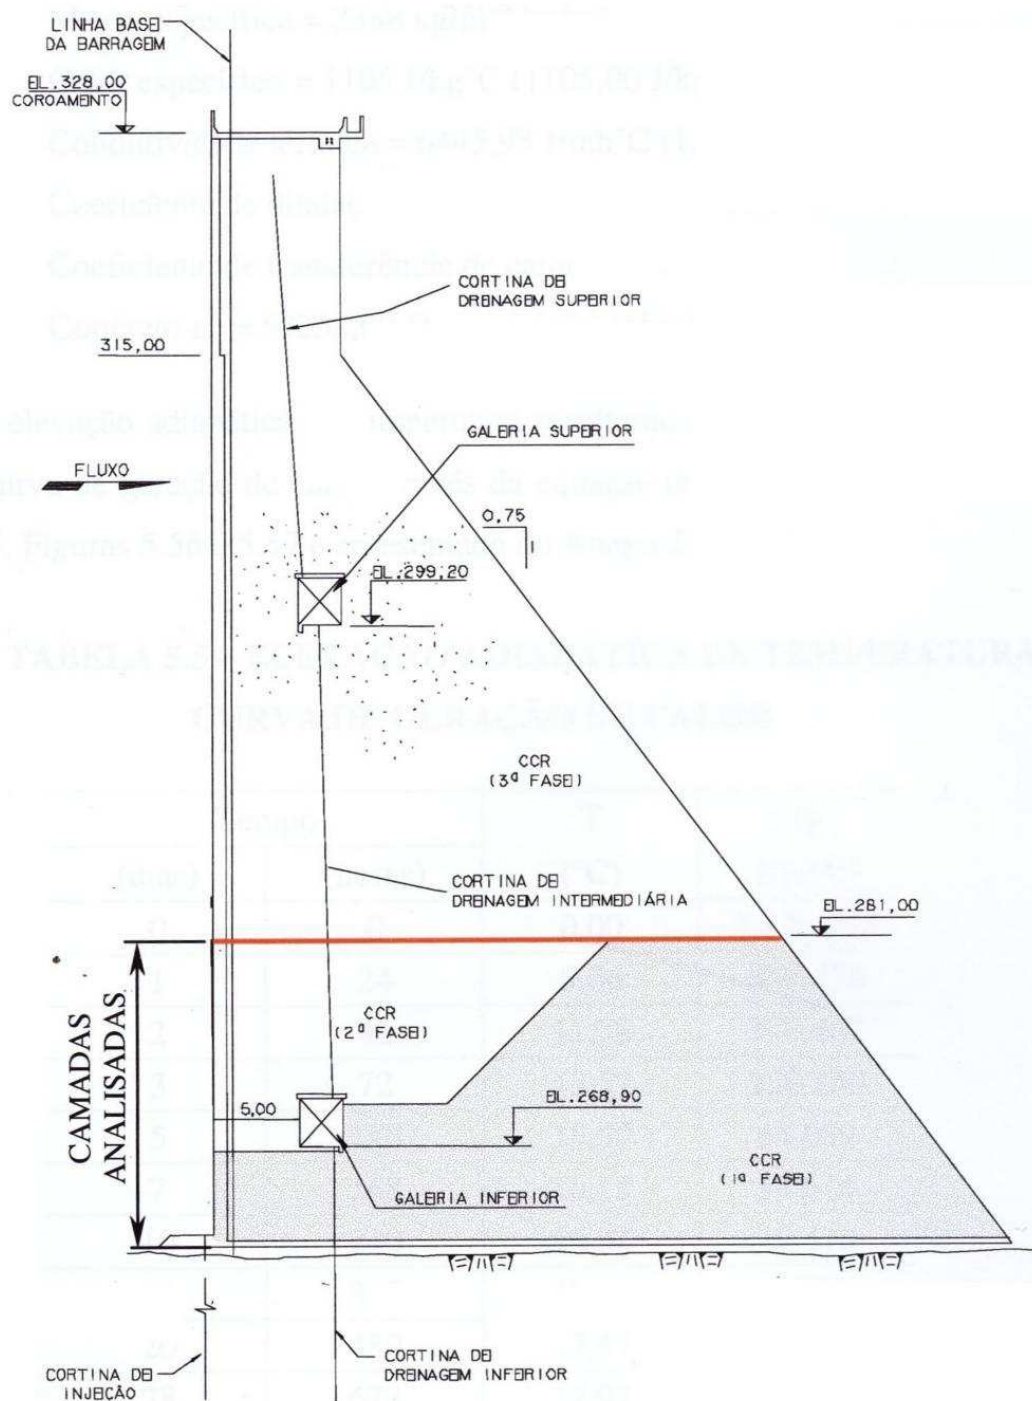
Bloco B-08 – Seção típica analisada e fases construtivas
